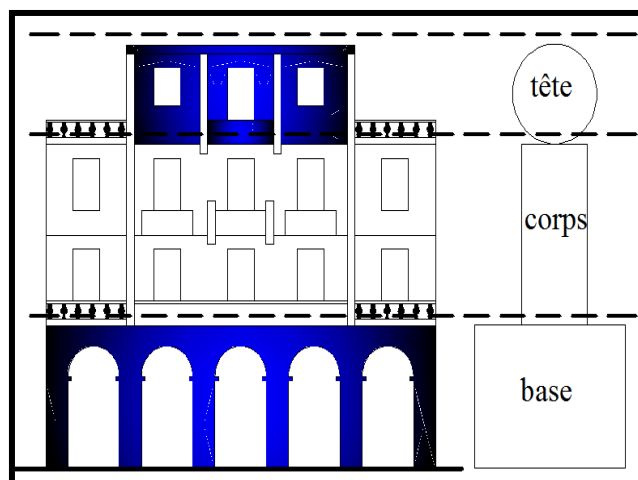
Hauteur de la façade de l'immeuble BEA
